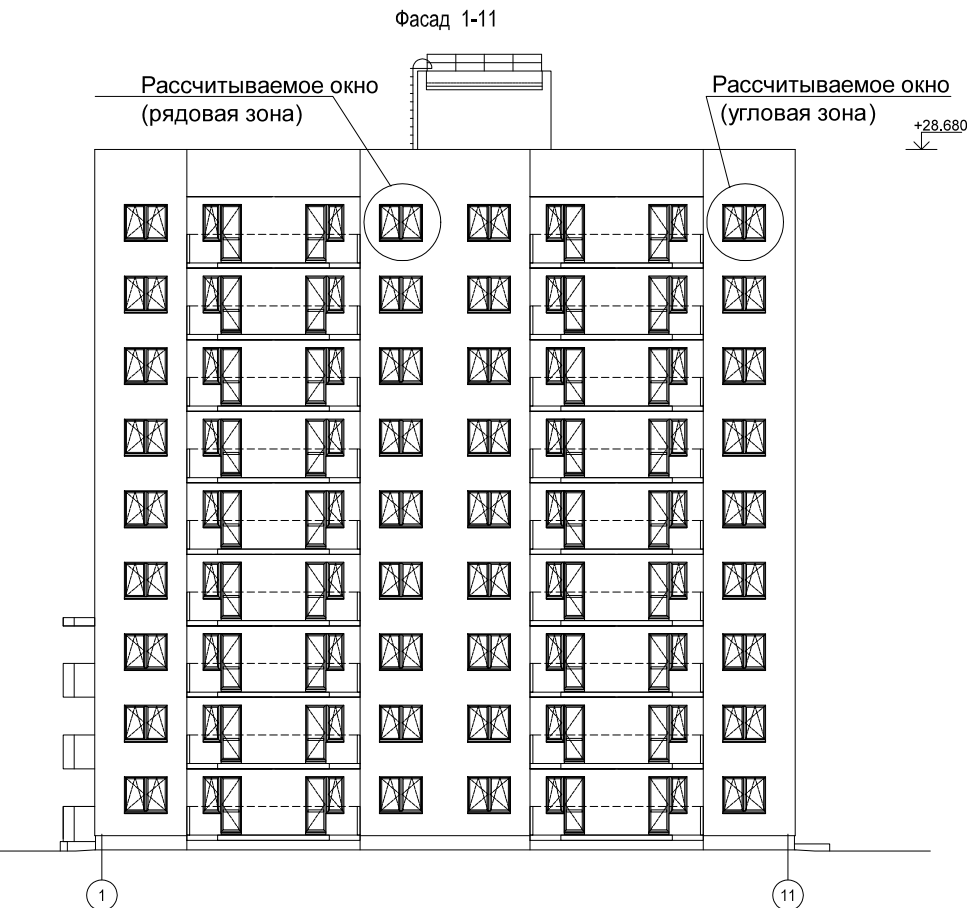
Фасад здания с указанием места рассчитываемых окон
